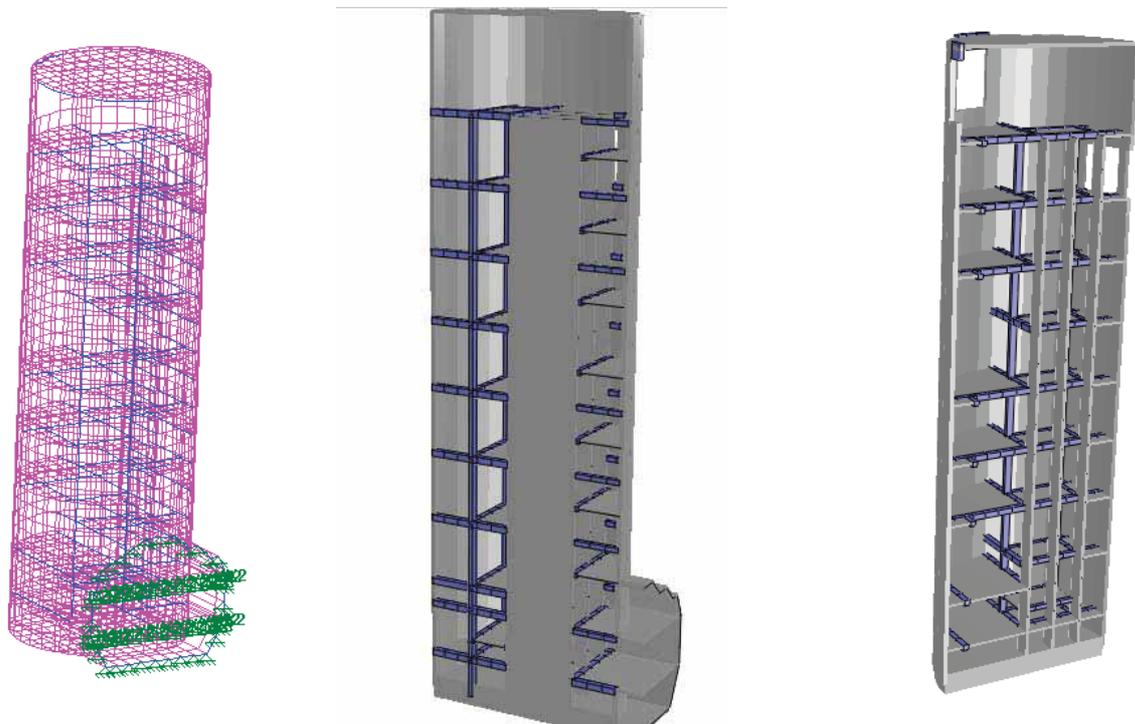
Poço de Emergência – Túnel de Ligação - Vista Central - e Esquema de Cálculo
